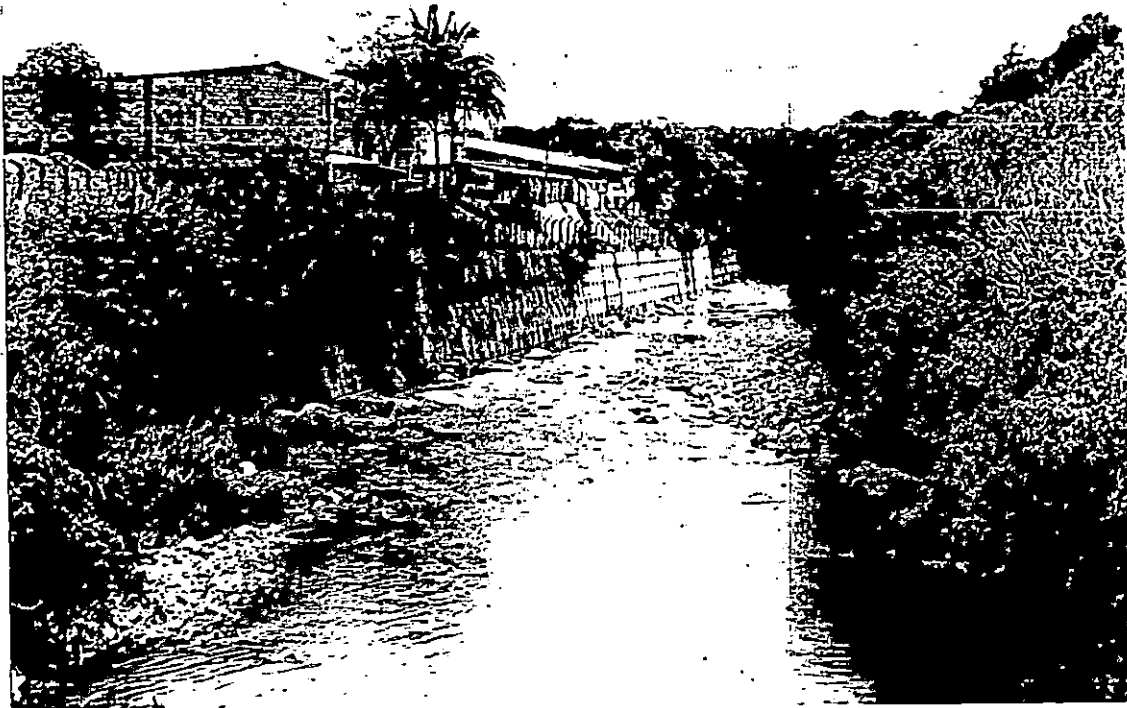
Muro de concreto armado al costado oriente de Industrias Eureka.
